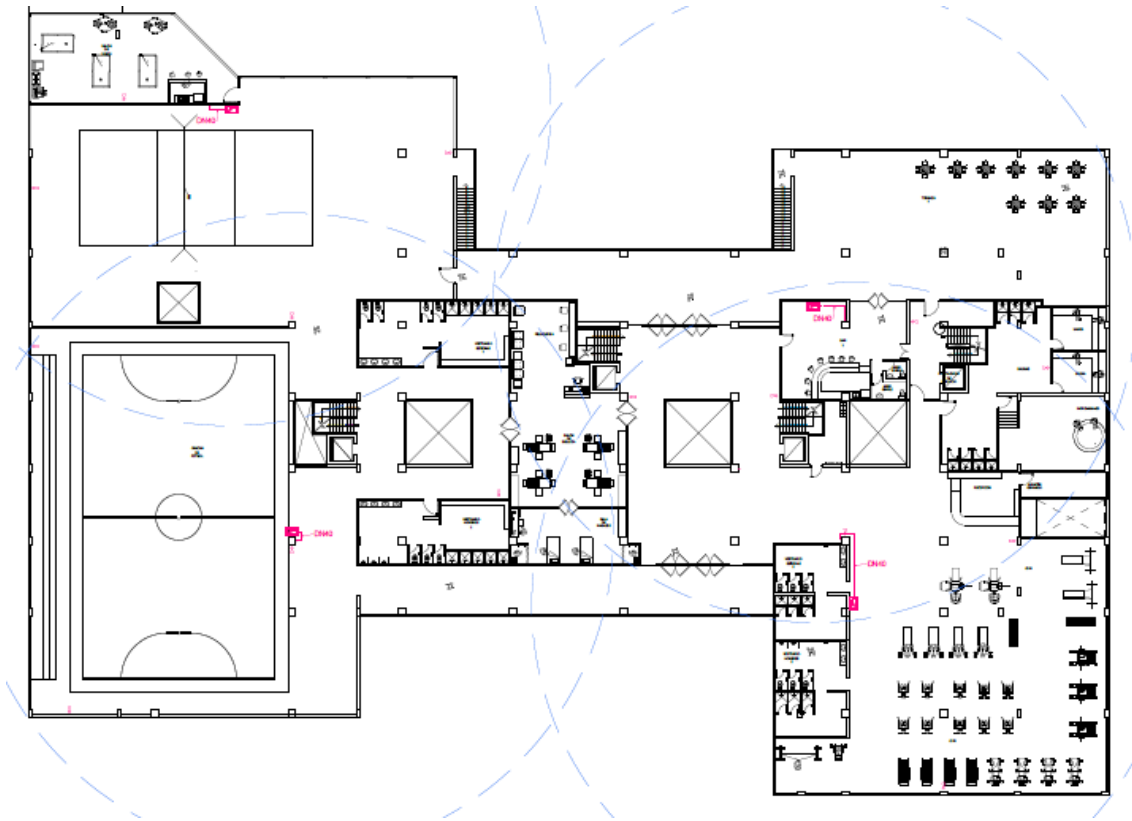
Ubicación BIEs y alcances. Planta 1ª. Planos del proyecto
